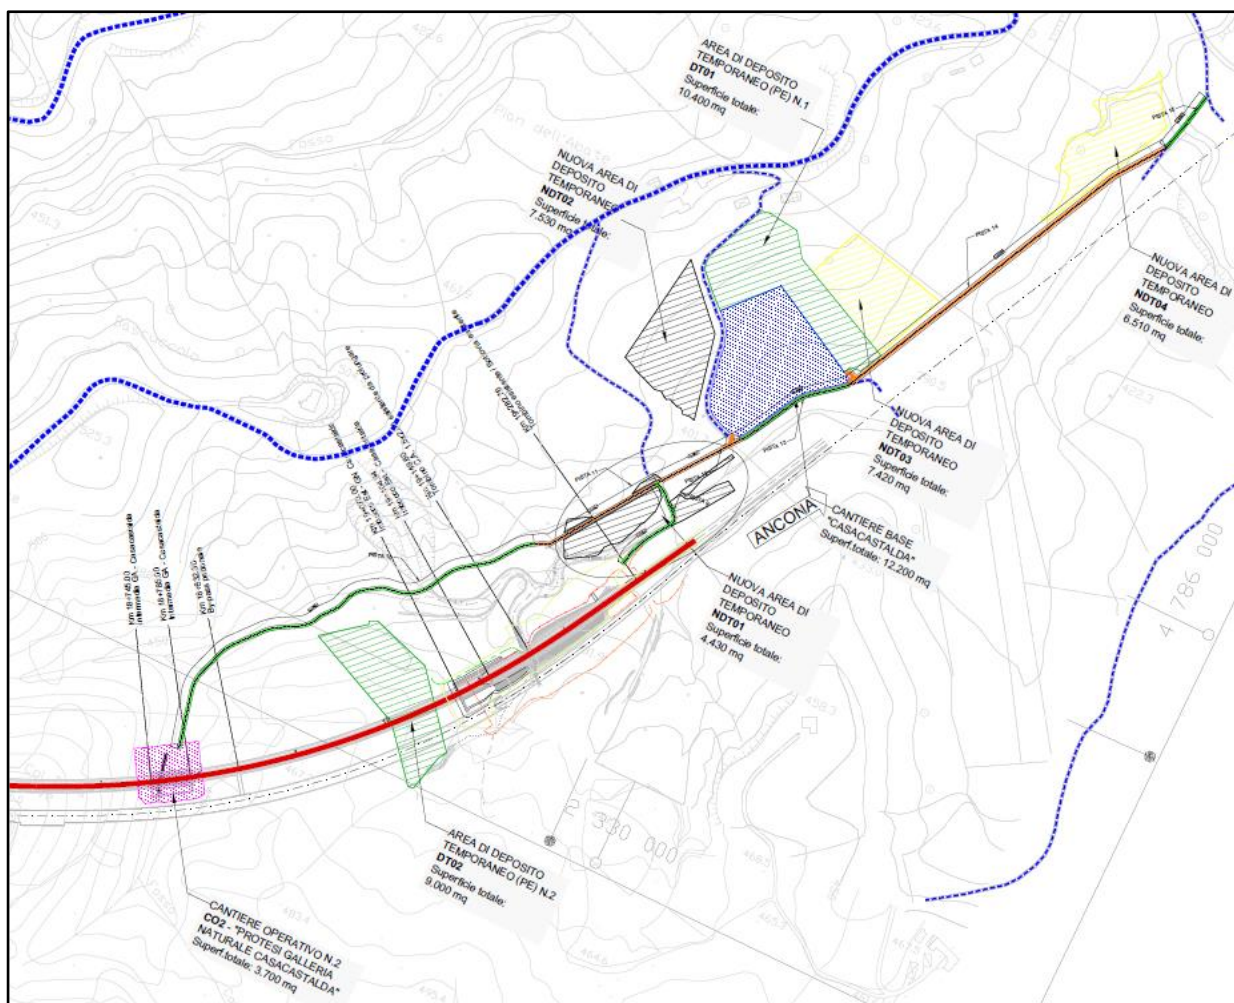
Stralcio planimetrico con individuazione delle aree di stoccaggio e deposito intermedio
